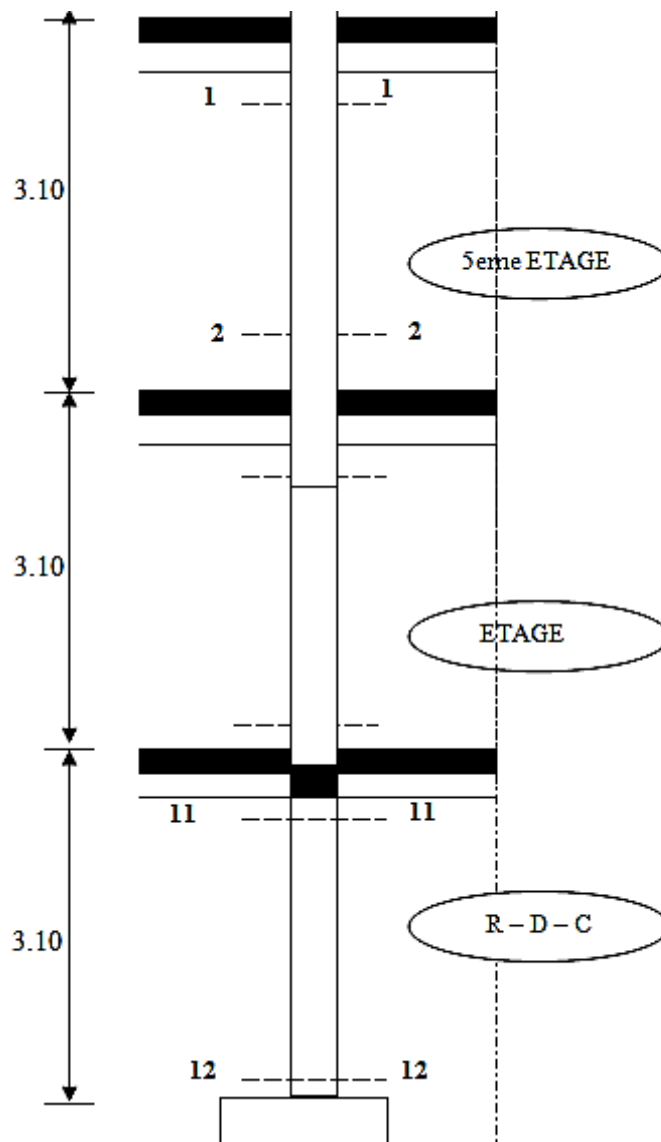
Schéma des sections de calcul des poteaux (Coupe en élévation).
